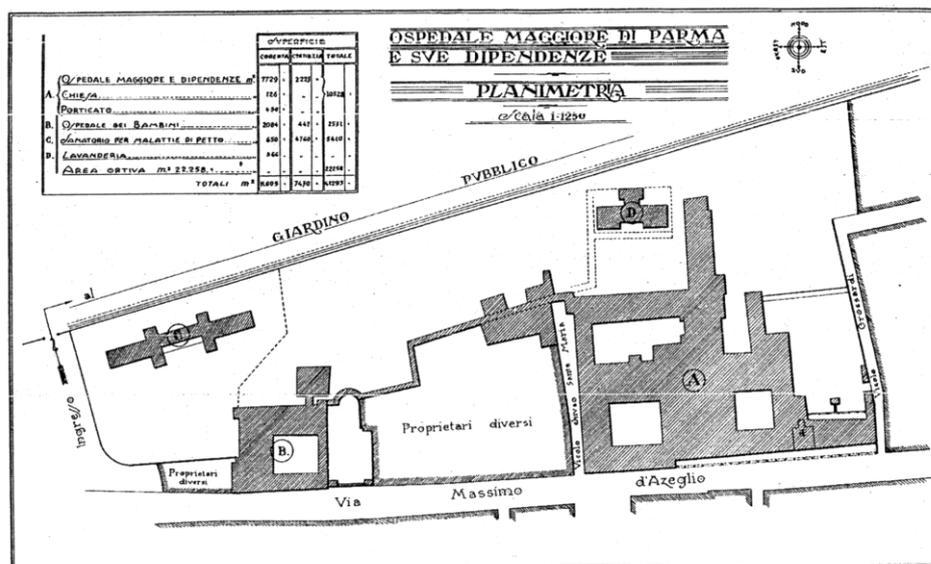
Planimetria del 1926 dei locali liberati con il trasferimento delle strutture ospedaliere nel nuovo ospedale.<sup>5</sup>
